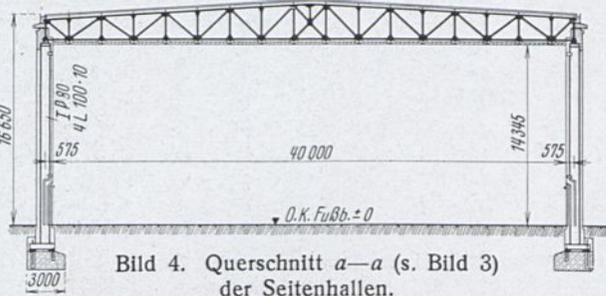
Querschnitt a-a (s. Bild 3) der Seitenhallen.
